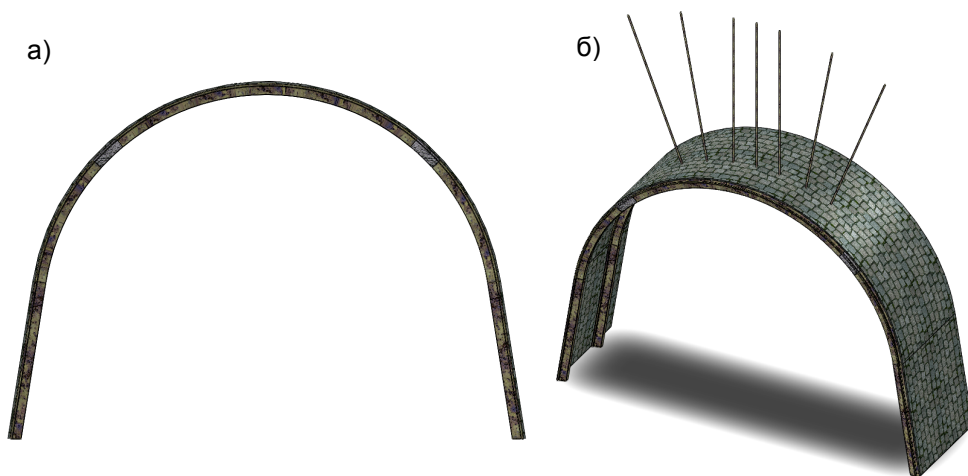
Конструкция крепи базового участка конвейерного квершлага: а) форма поперечного сечения; б) общий вид
